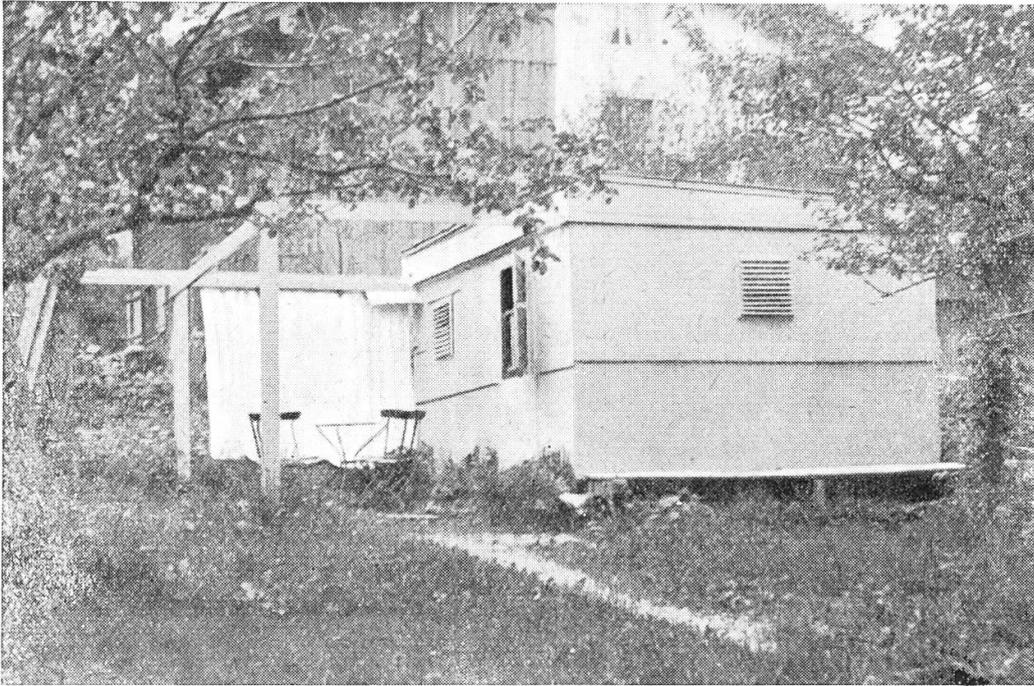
Aussenansicht der Beobachtungshütte mit den Stützen für das abfahrbare Dach, das leicht geneigt ist.
